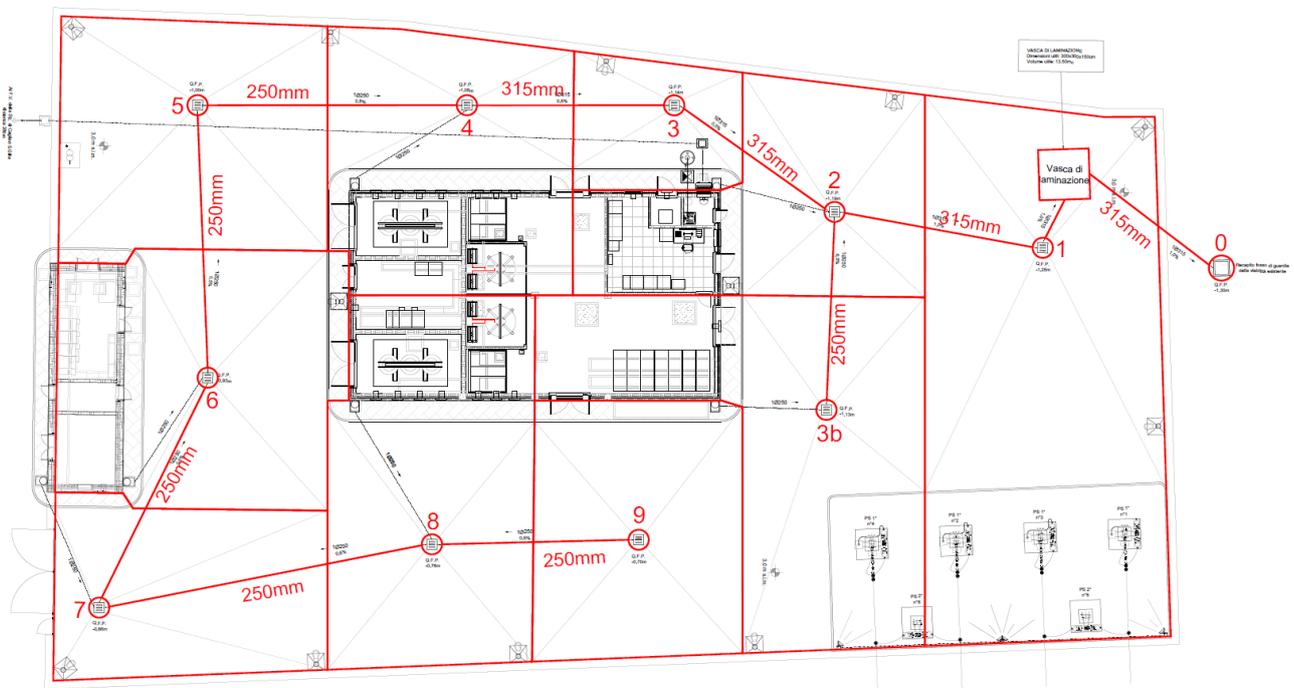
SSE Cagliari - Stralcio planimetro della rete di drenaggio adottata per il piazzale.
